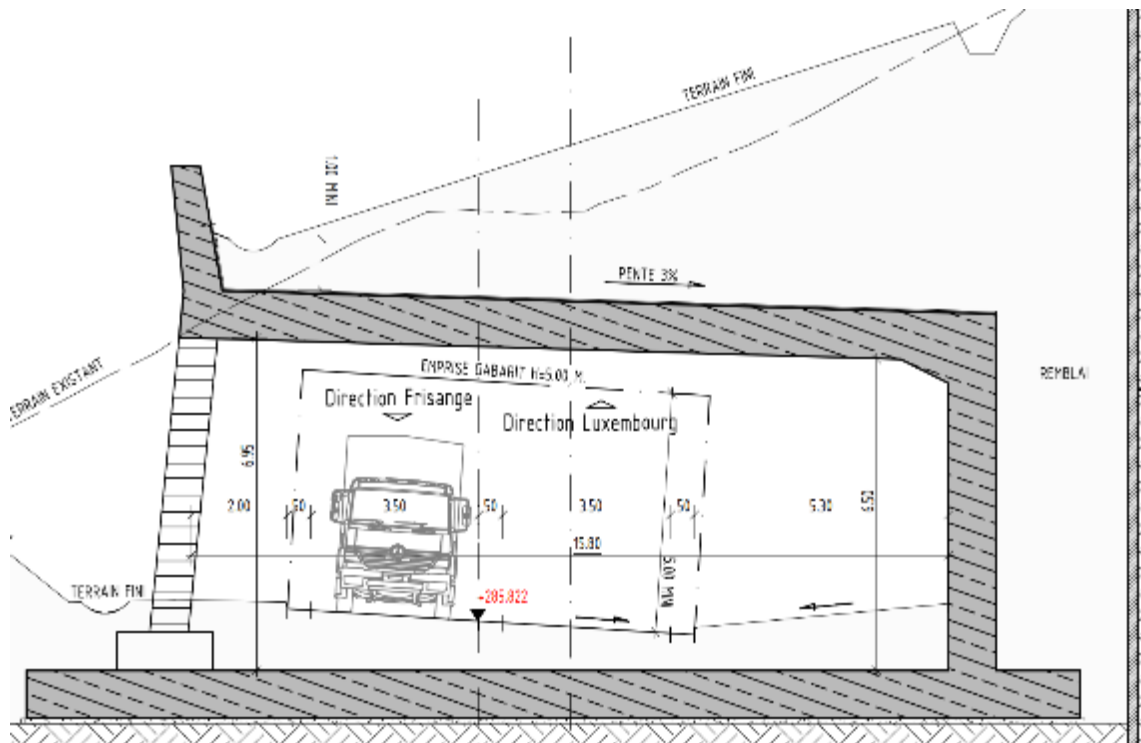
Coupe transversale de la galerie P.F.03 / OA1518
